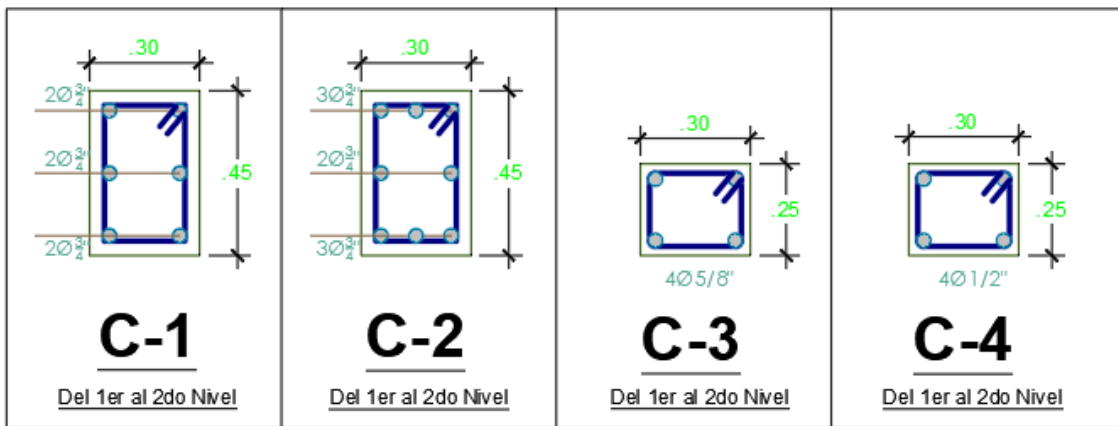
Secciones transversales de columnas, Piso 2 - Bloque 2
